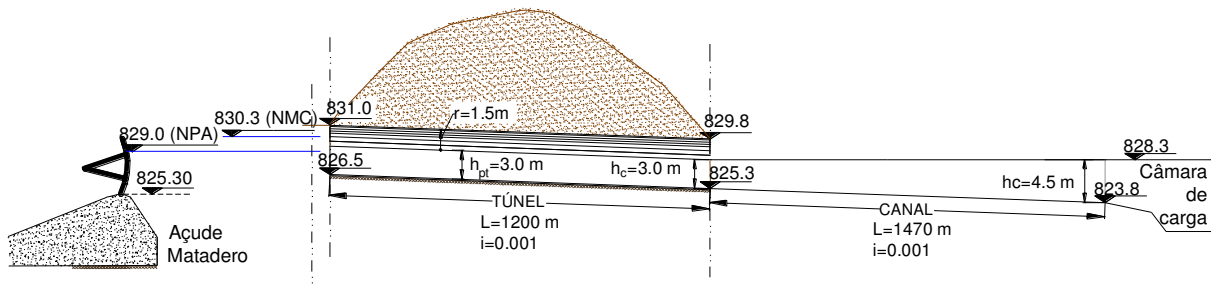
Perfil longitudinal esquemático do túnel e canal entre o açude Matadero e a câmara de carga.
